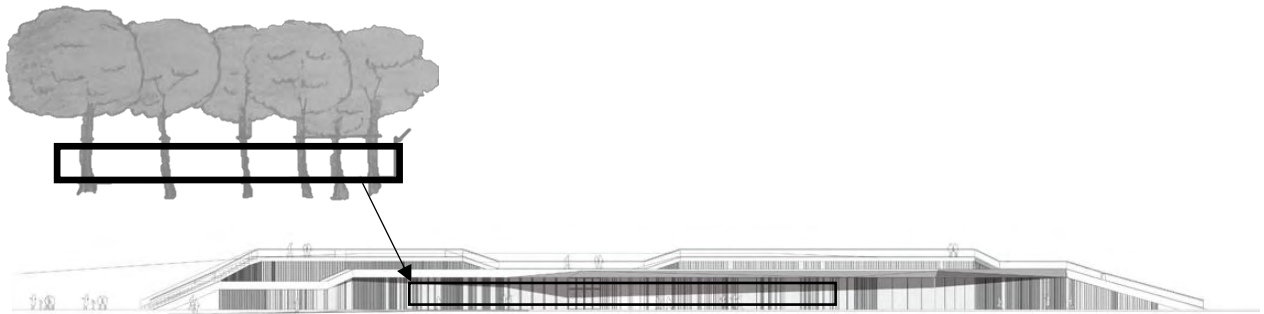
elevación fachada sur Fuente: <https://www.archdaily.co/co>
